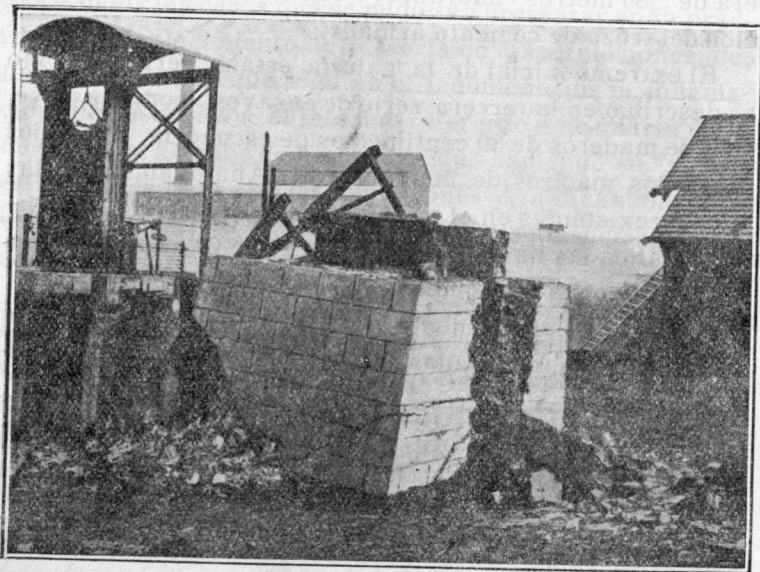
Destrucción del fondo de la galería por el ensayo 218.
